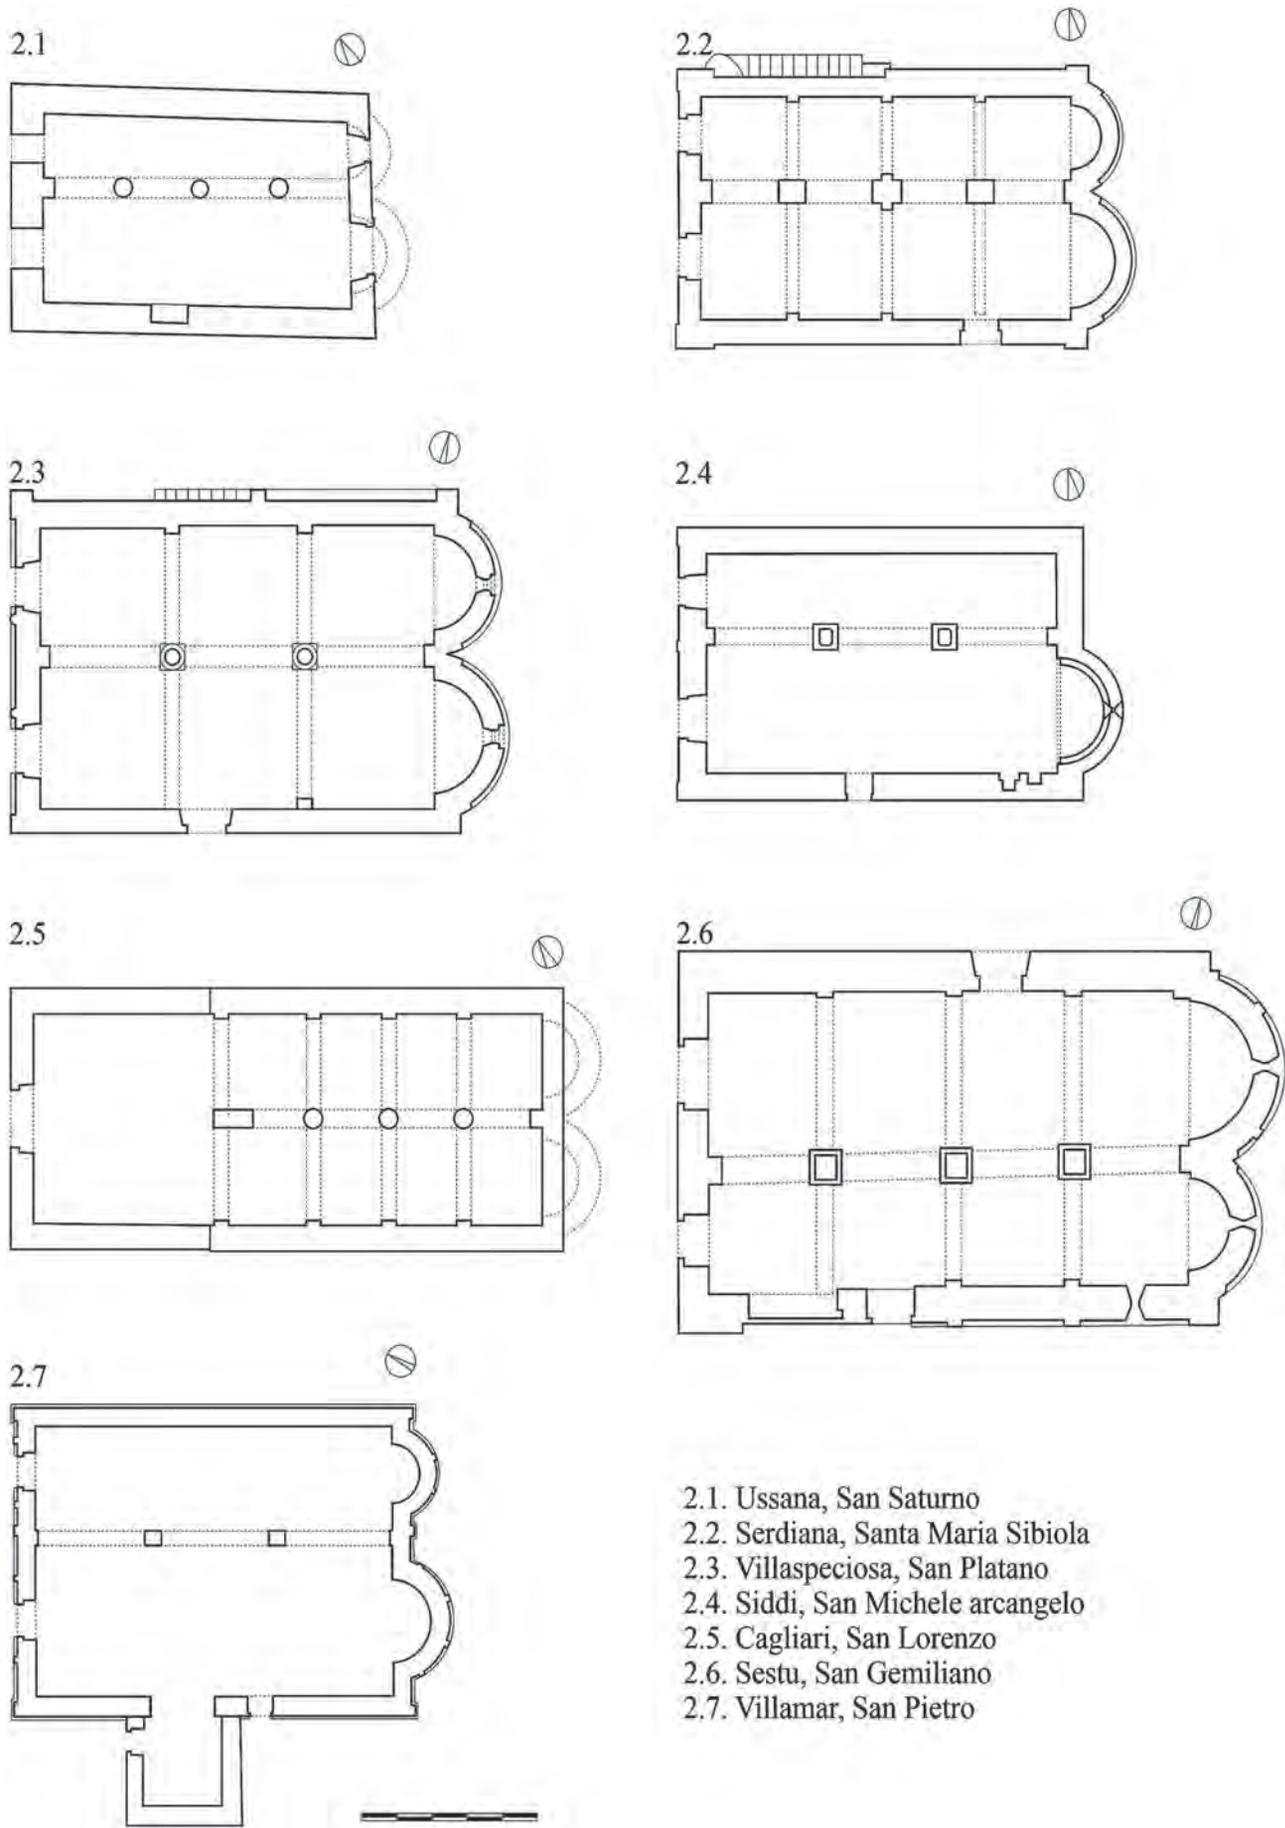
Sardegna, Planimetrie delle chiese (disegni dell'autrice).
